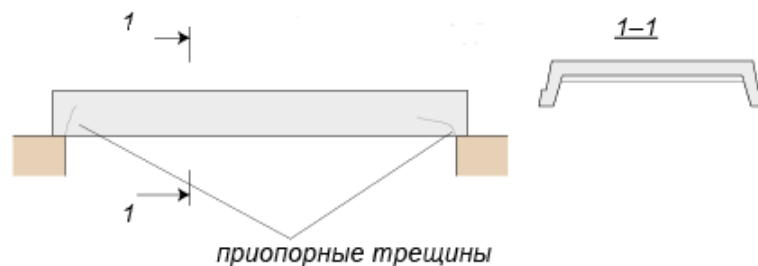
Возможные повреждения в растянутой зоне бетона
